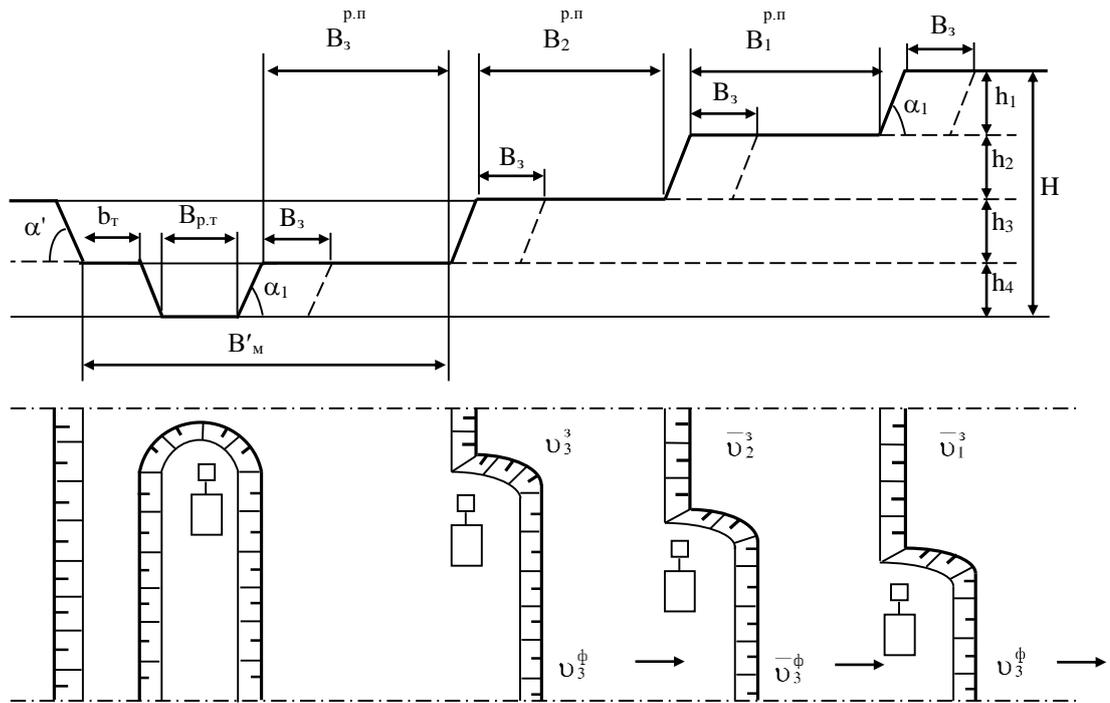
Схема рабочей зоны карьера и подготовки нового горизонта
